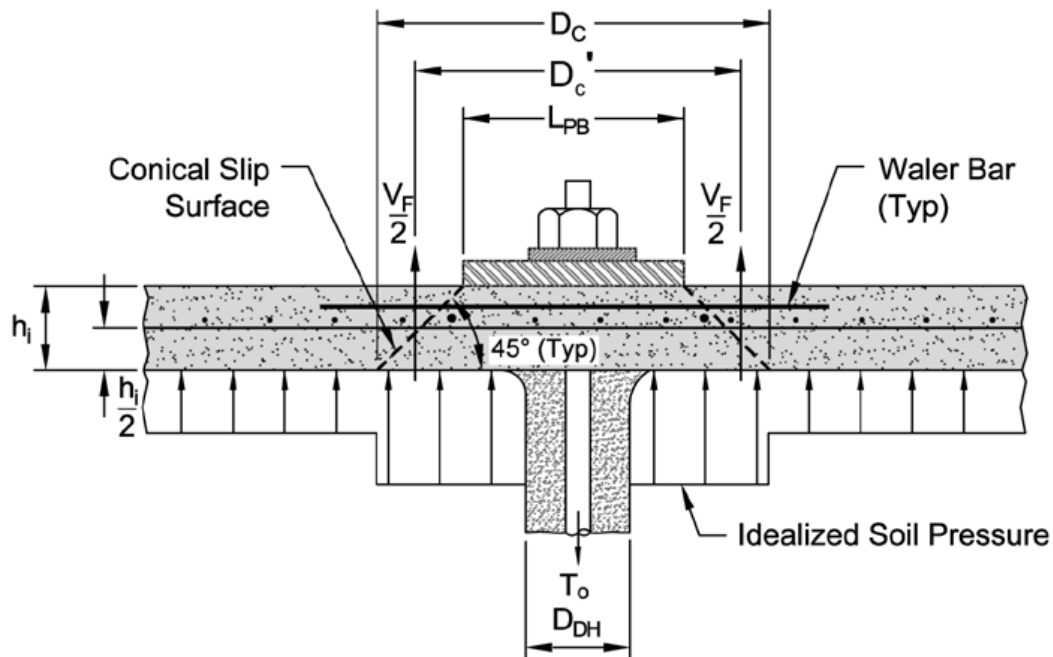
Esquema de influencia del esfuerzo de punzonamiento en cabeza de clavo (Fuente: Soil Nail Walls – Reference Manual (FHWA, 2015))
